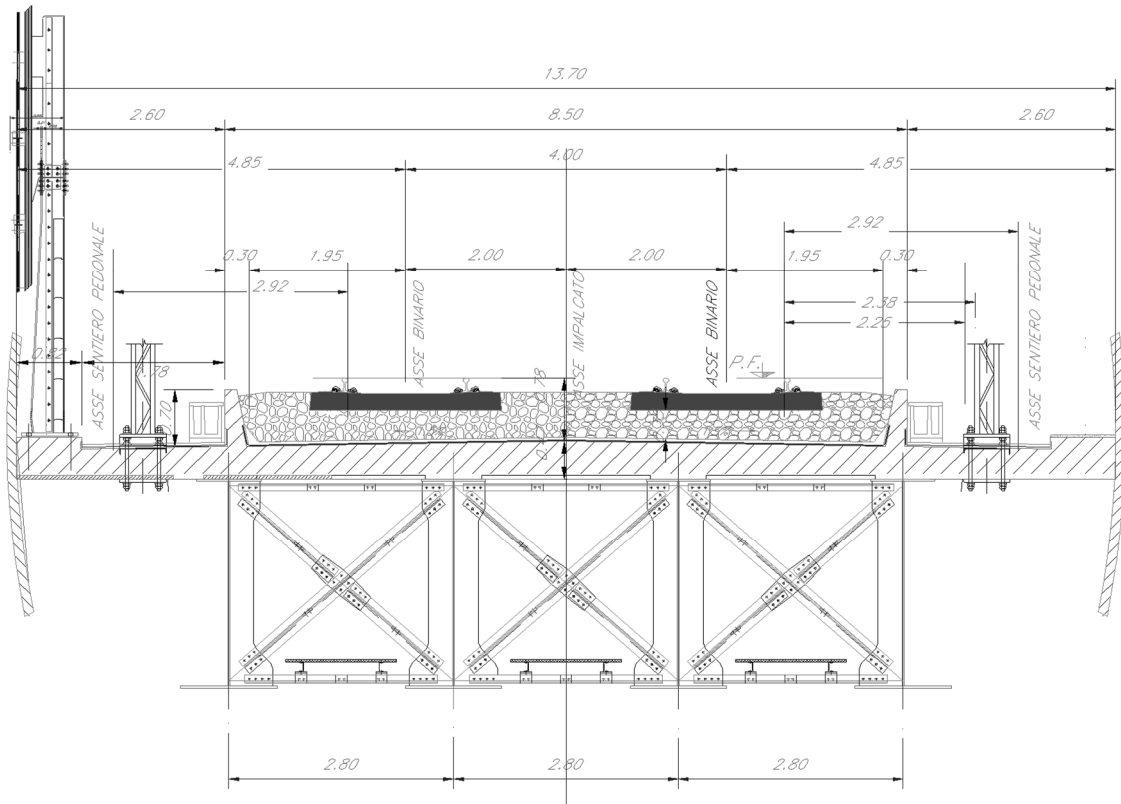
Sezione tipo in viadotto – Sezione mista acciaio-calcestruzzo DB
